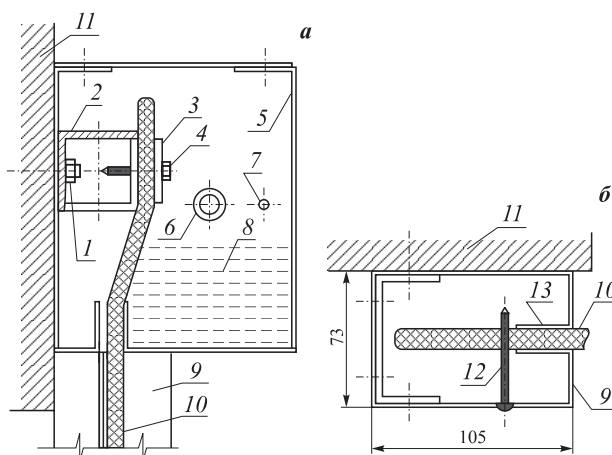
Поперечное сечение корпуса (а) и направляющих элементов (б) образца противопожарной шторы: 1 — анкер; 2 — несущий элемент; 3 — полоса стальная; 4 — винт самонарезающий; 5 — корпус; 6 — штуцер подачи воды; 7 — индикаторное отверстие; 8 — вода; 9 — направляющий элемент; 10 — рабочее полотно; 11 — железобетонный вкладыш; 12 — винт самонарезающий; 13 — лента термоуплотнительная
